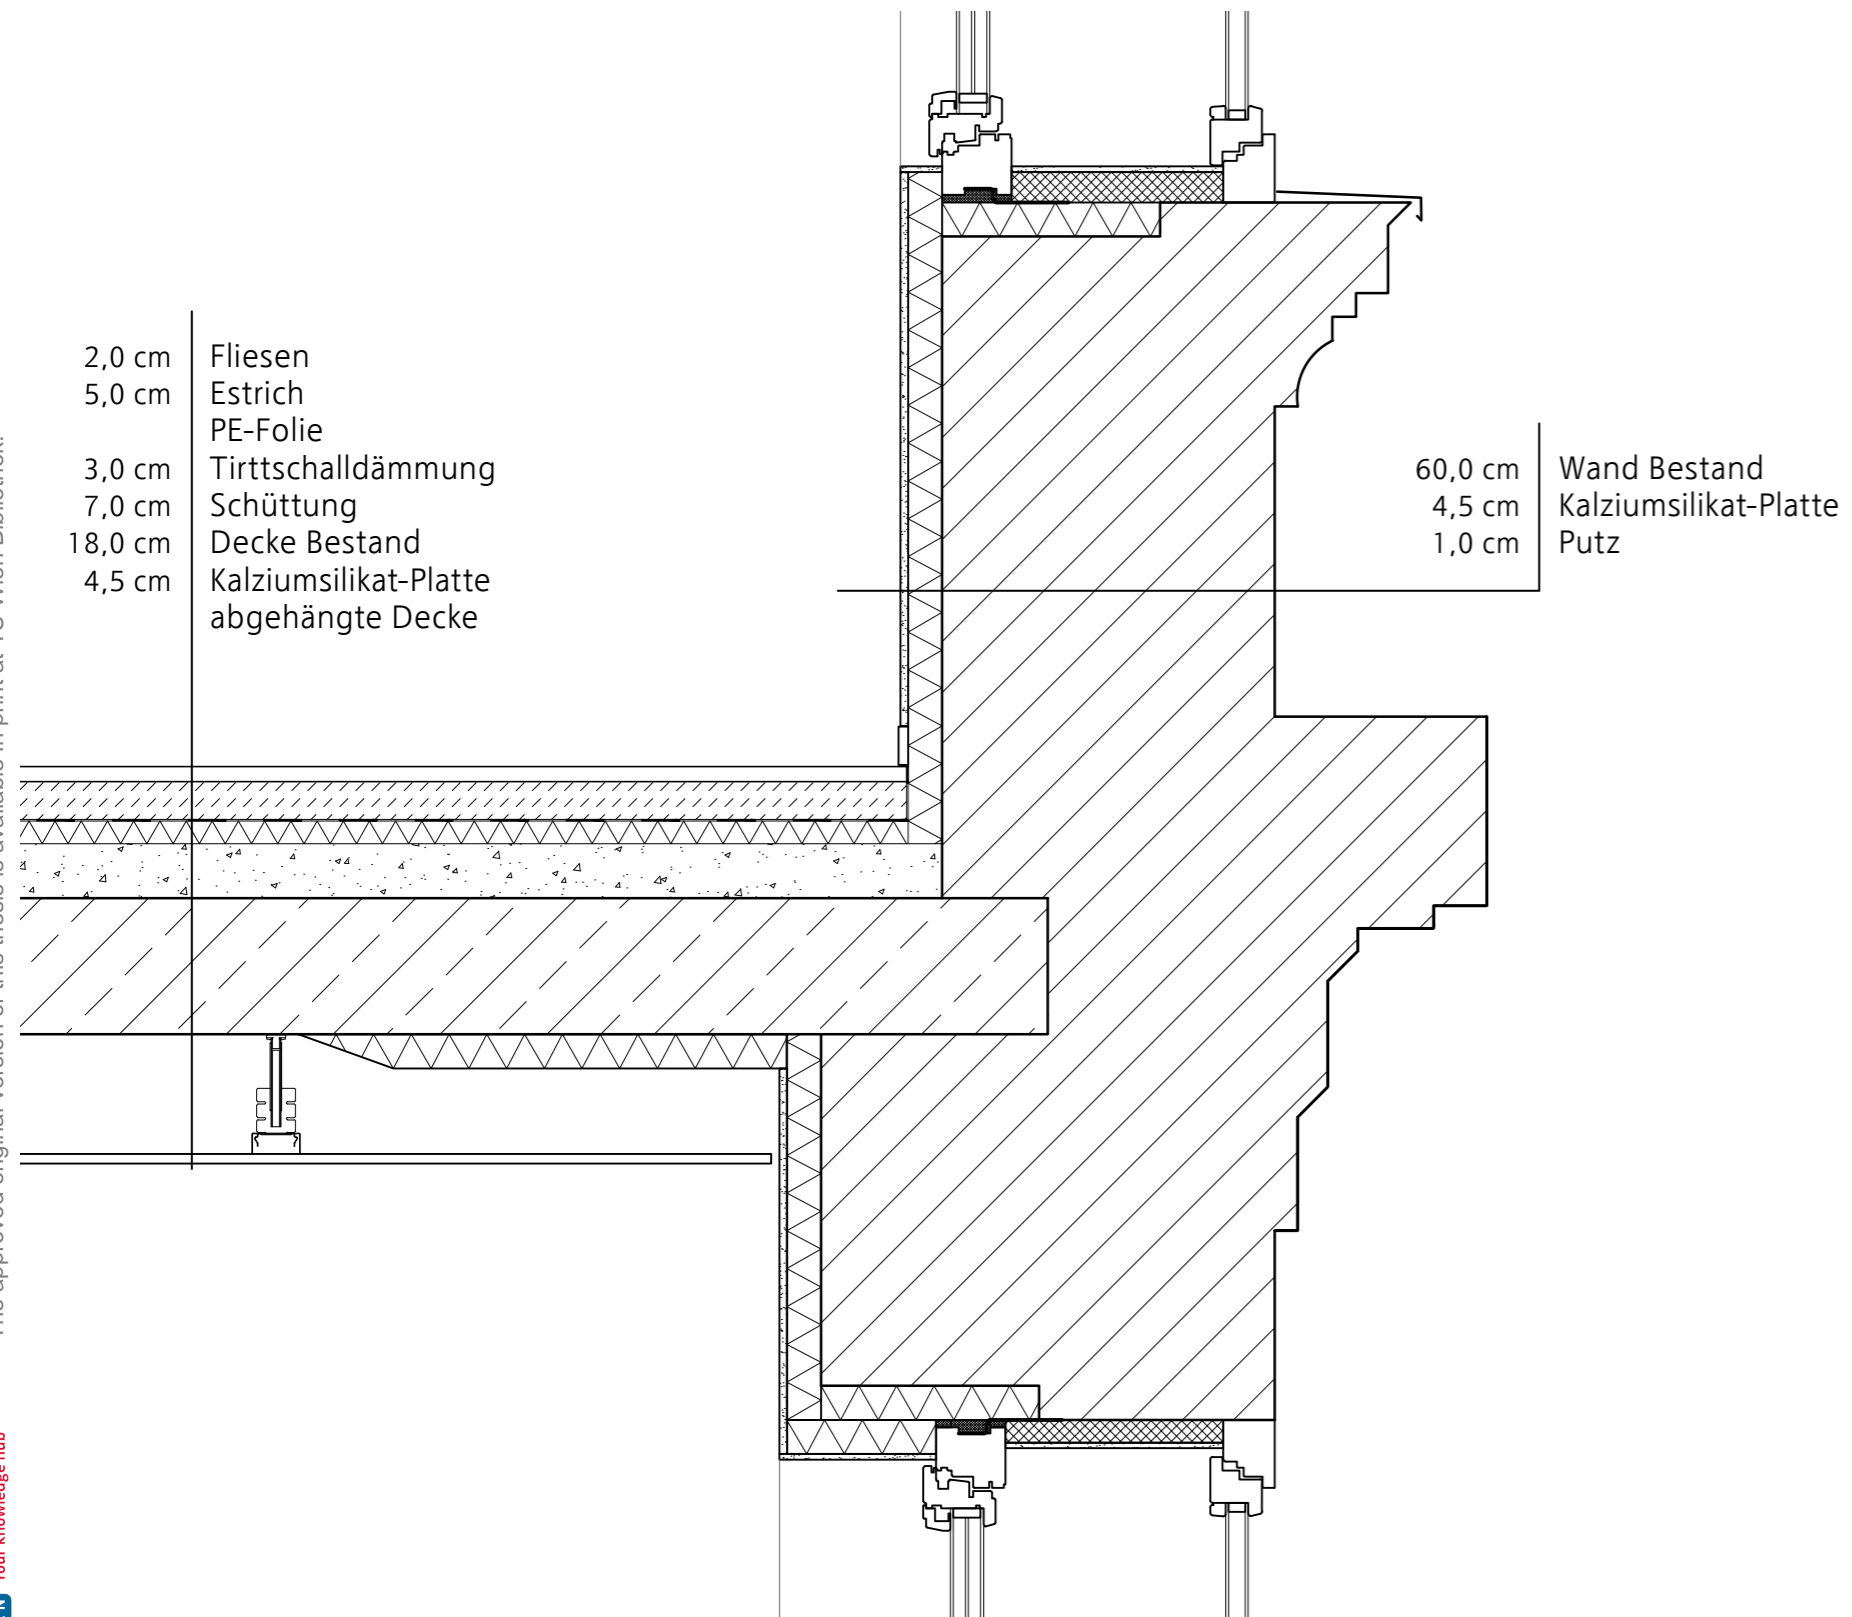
Fassadenschnitt Zwischendecke | M 1-10
